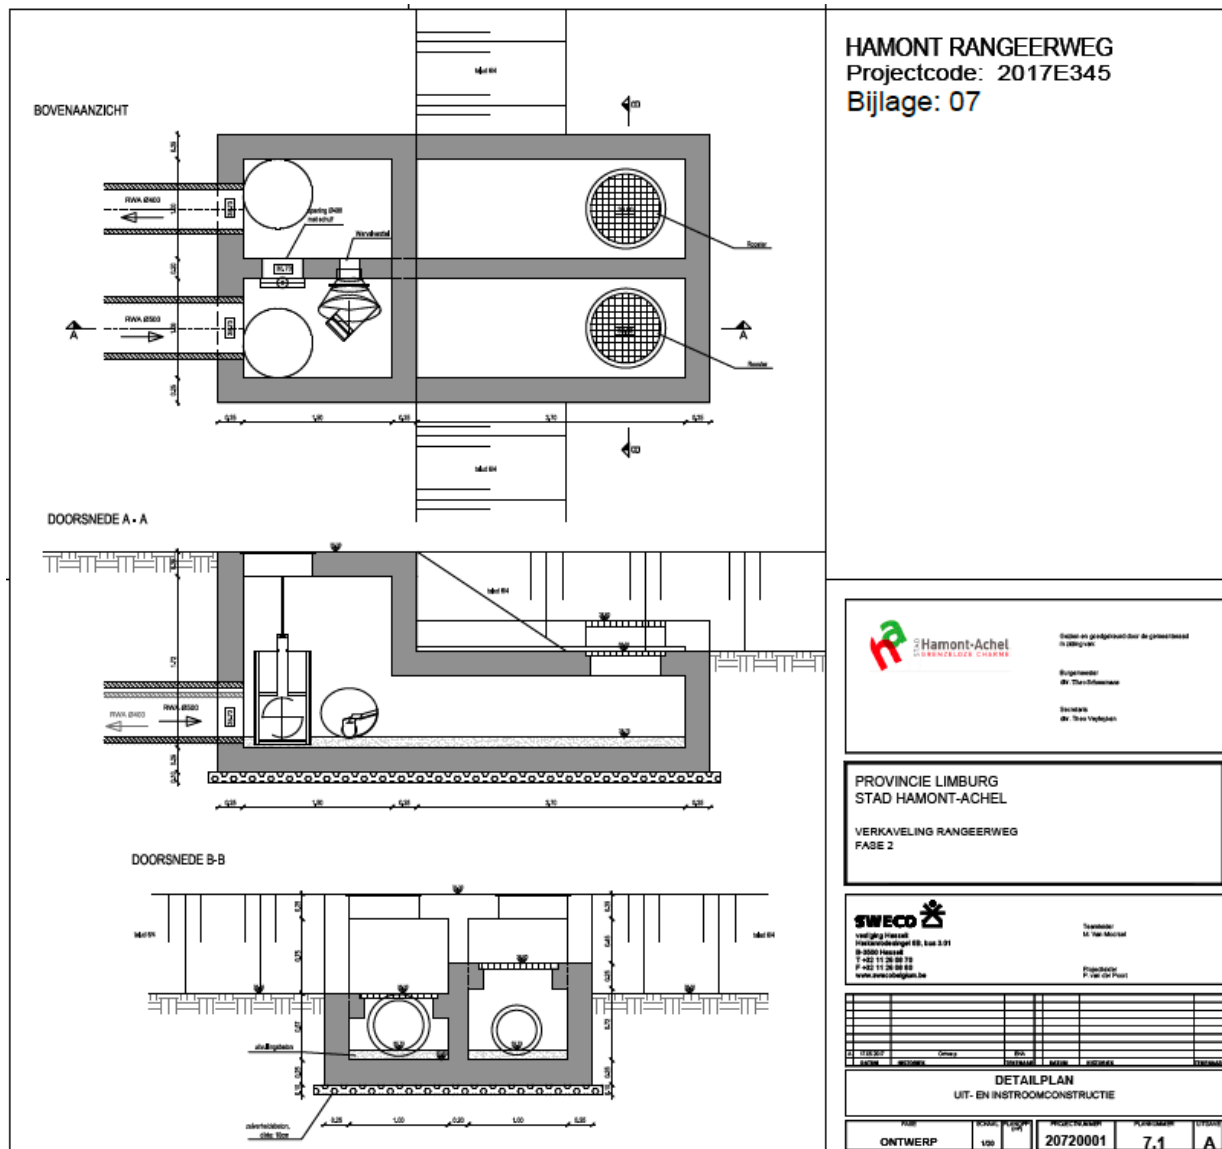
In- en uitstroomconstructie voor RAW-leidingen
